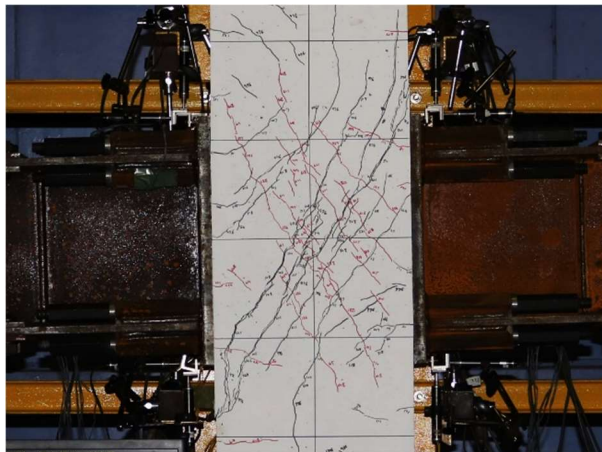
最大耐力時のひび割れ状況(No. 2)
